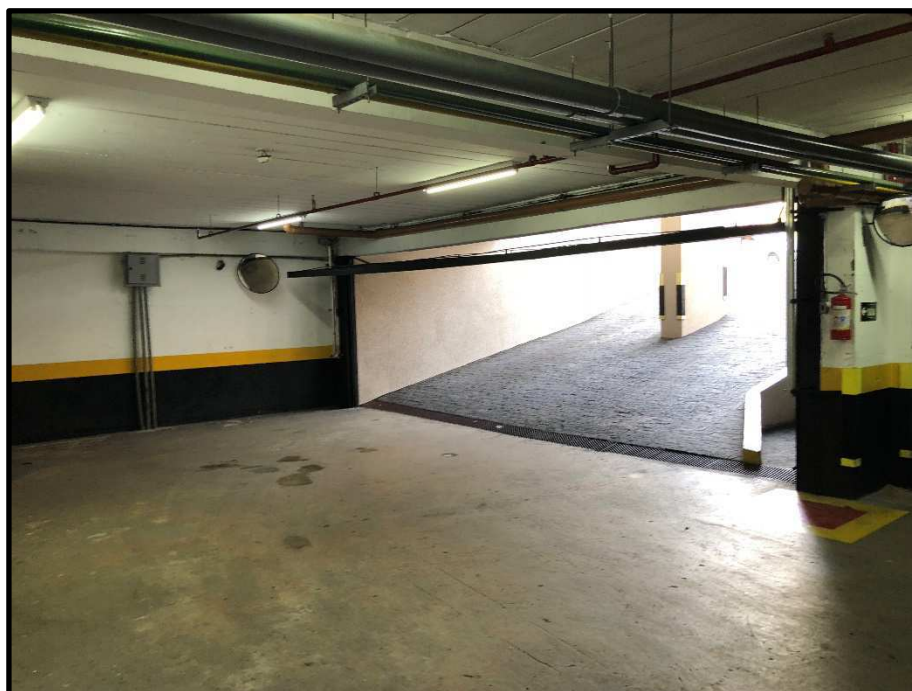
1º subsolo – vagas de garagem – Vista 4
